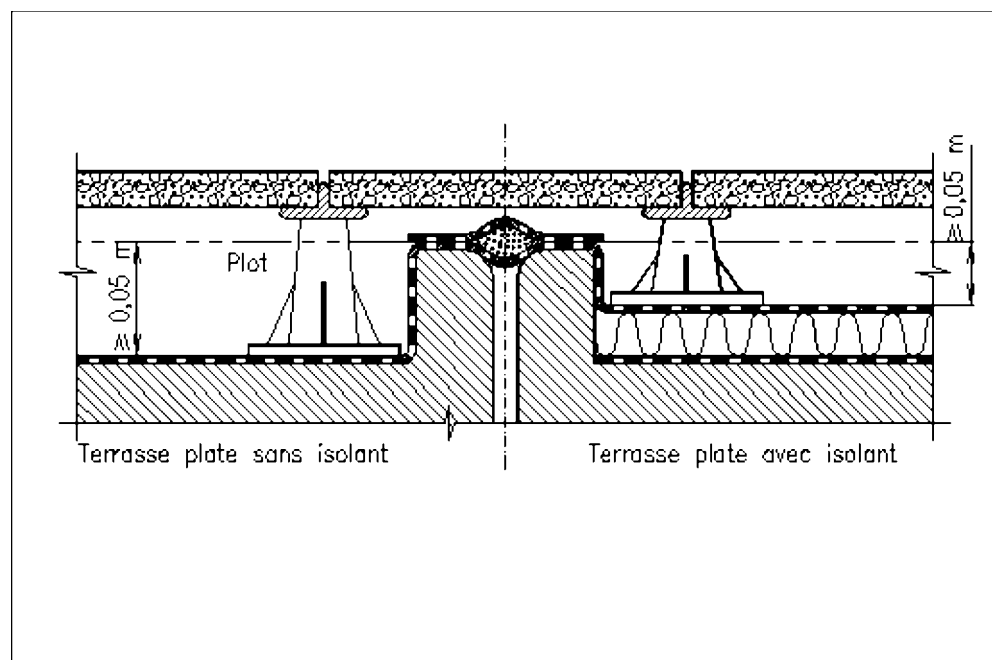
Exemple de joint plat surélevé - Terrasse dalles sur plots posés sur protection dure traditionnelle
